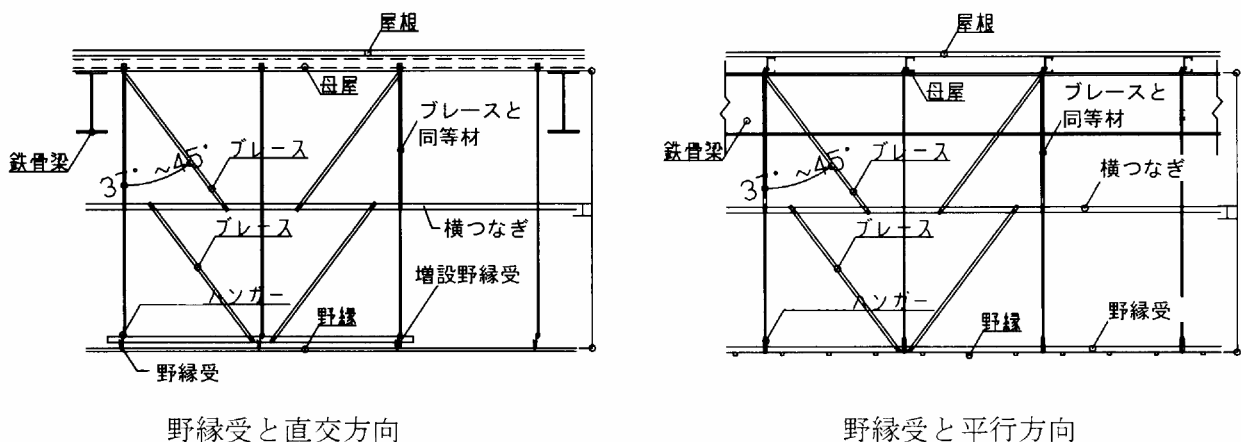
8-2 天井懐H=1500mmを越える場合のブレース配置の断面例
